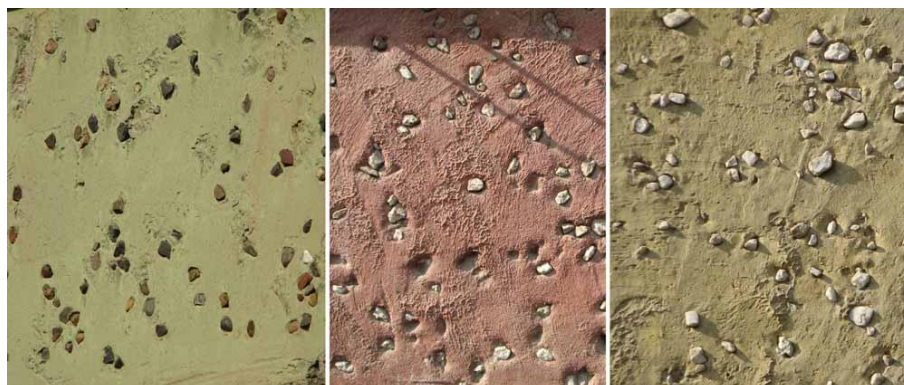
Фасад серии 1-464. Включение каменной крошки в железобетонную панель. Фото наши дни
